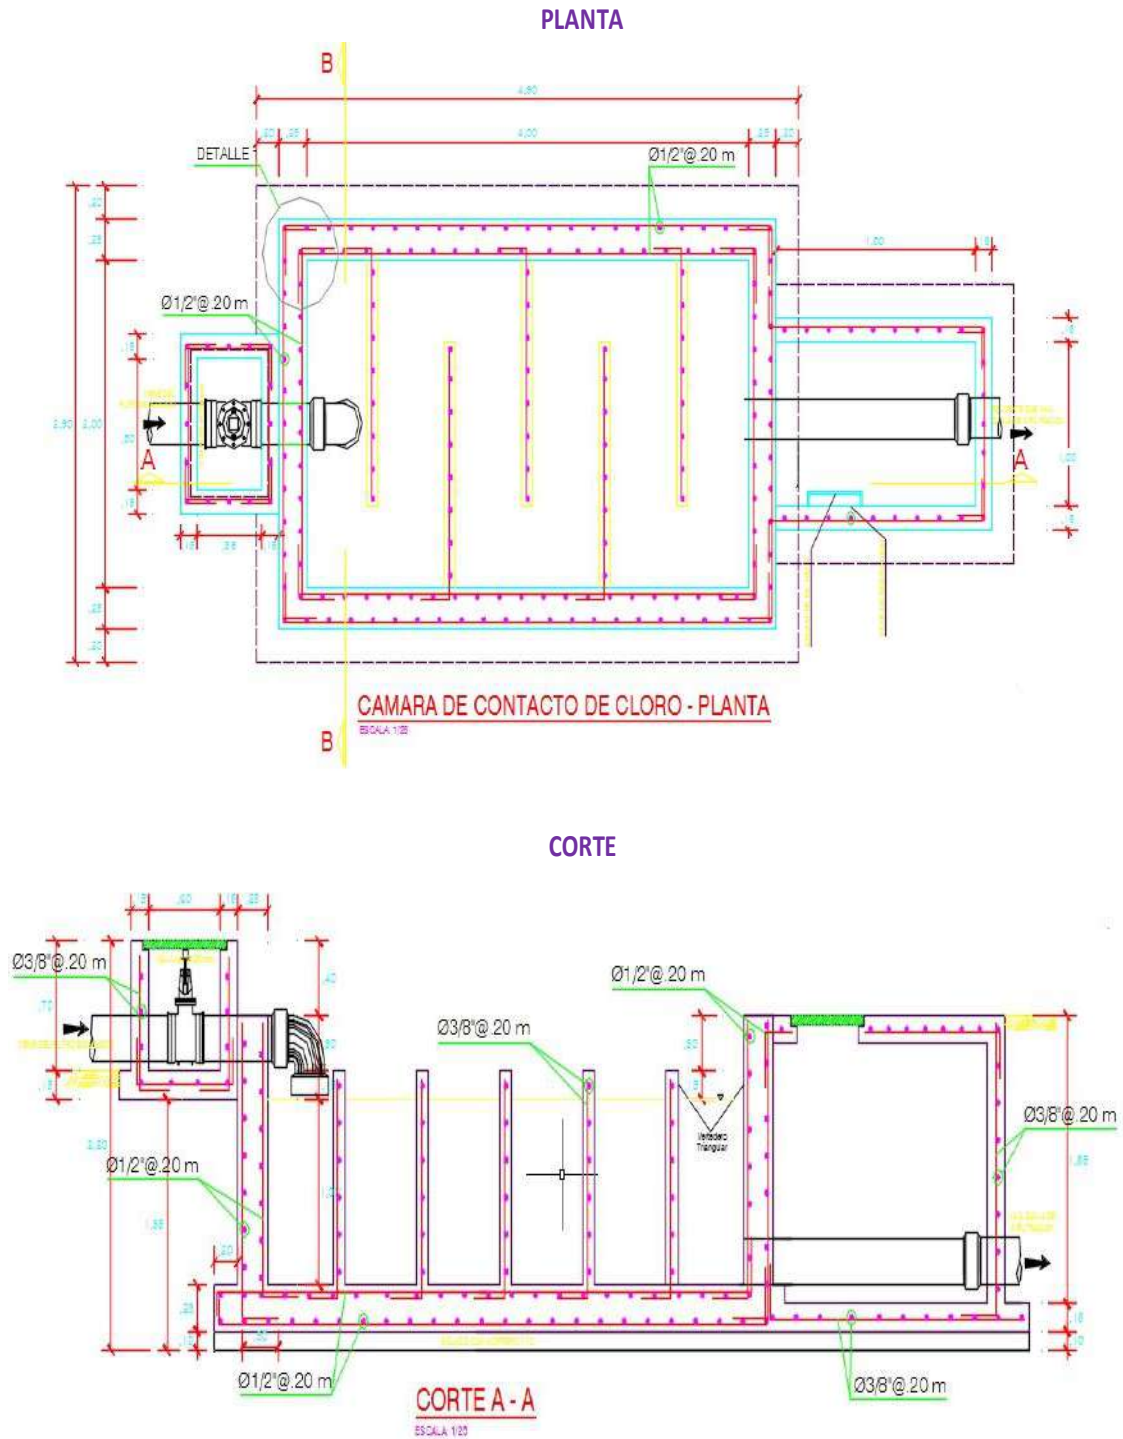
Planta y Corte Cámara de Contacto de Cloro
